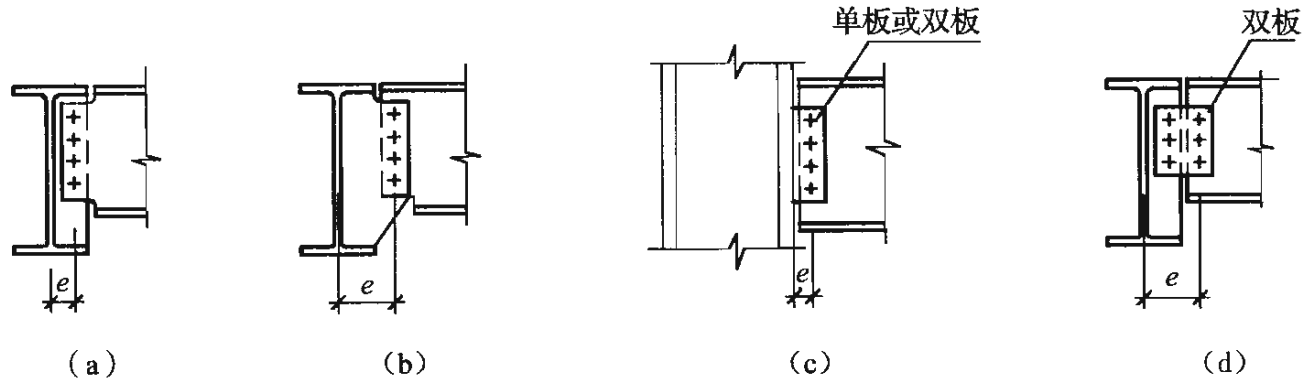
次梁与主梁（或与柱）的简支连接构造
